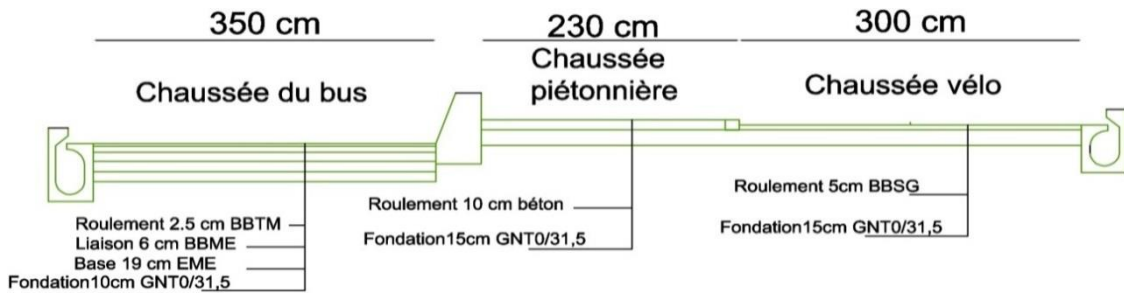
Chaussées proposées pour le chemin aérien (mêmes chaussées pour le tunnel modes doux)
